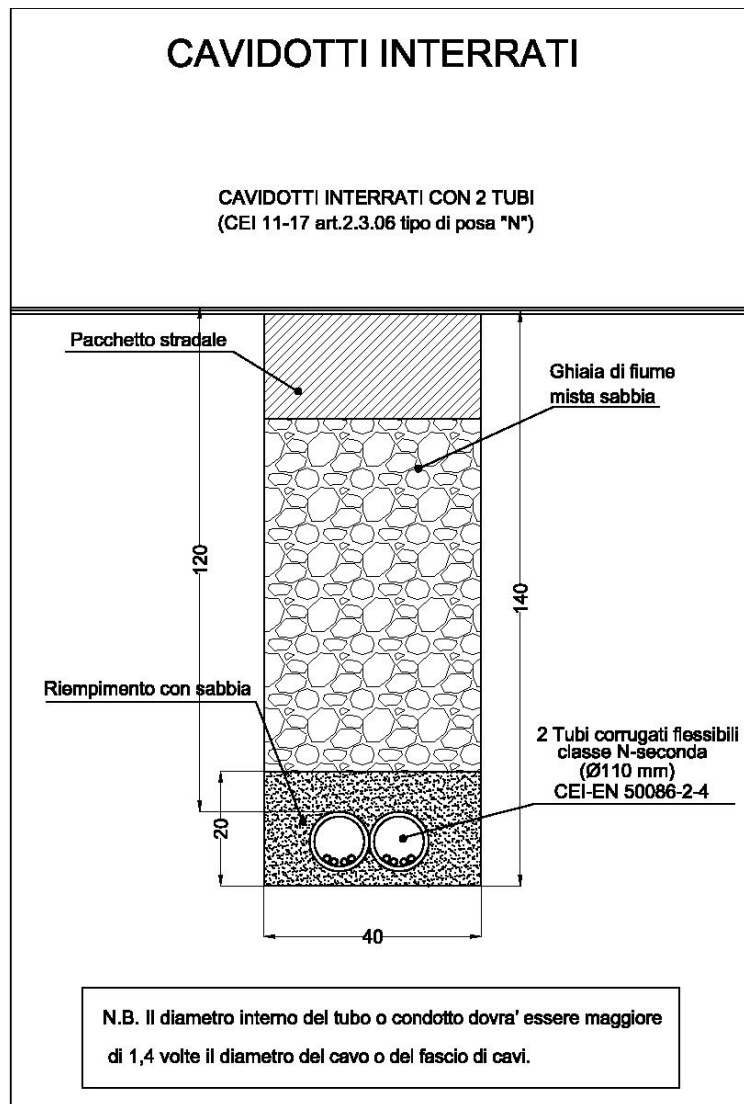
Rete illuminazione pubblica primaria – Sezione di posa
